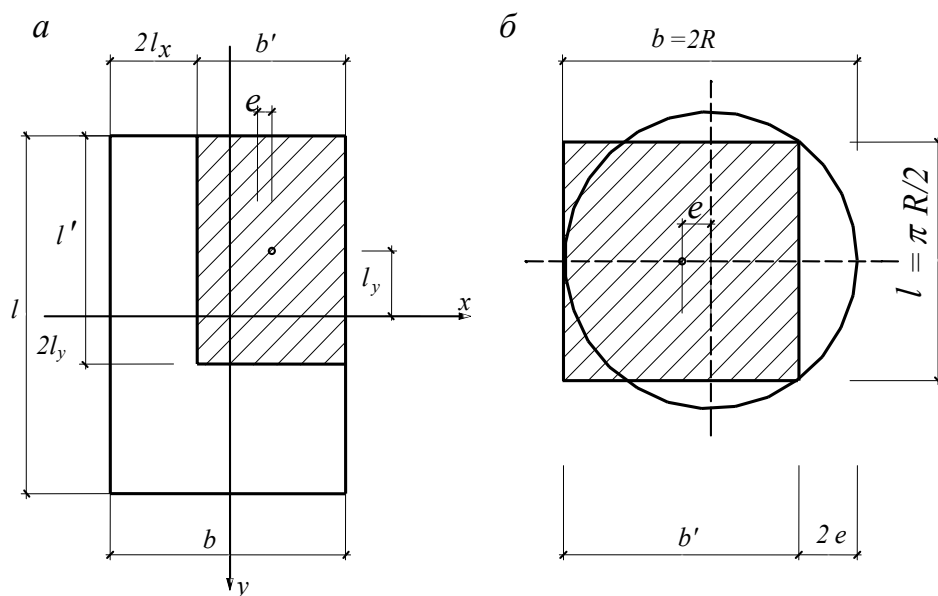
Схемы определения приведенных размеров подошвы прямоугольного (а) и круглого фундаментов (б)
